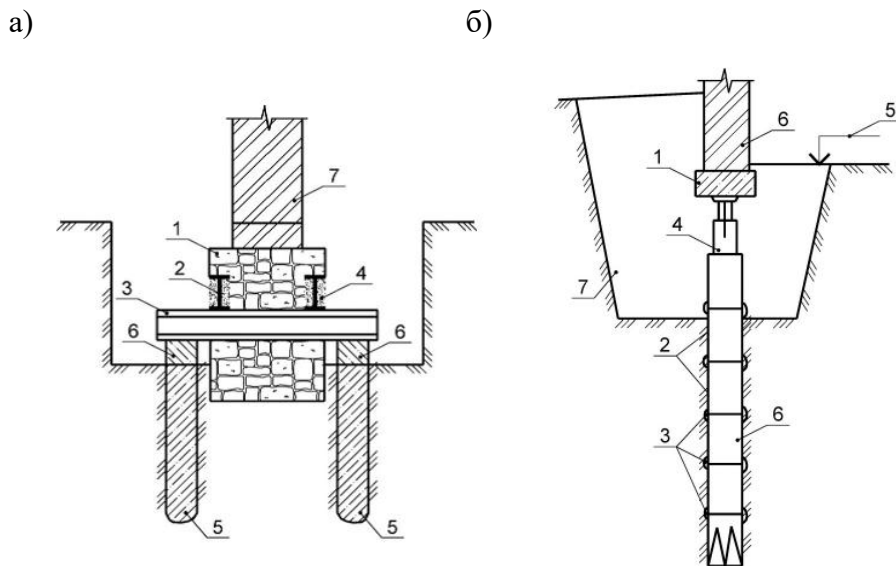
Увеличение несущей способности ленточных фундаментов путем передачи части нагрузки от стены здания на сваи усиления: а) на набивные сваи, устраиваемые вдоль фундамента с передачей нагрузки на сваи посредством устанавливаемых в поперечном направлении металлических балок; 1- усиливаемый фундамент; 2- продольные металлические балки, установленные в штрабах; 3 – поперечная металлическая балка для восприятия и передачи нагрузки от вышерасположенных конструкций фундамента и стены; 4 – цементно-песчаный раствор для заделки устраиваемых штраб под продольные балки; 5 – набивные сваи; 6- железобетонная обвязка по сваям; 7 – кирпичная стена здания; б) на вдавливаемые сваи, устраиваемые под фундаментом здания: 1 – железобетонный ростверк; 2 – свая, погшружаемая вдавливанием (может быть из металлических труб длиной по 500 мм; 3 – места
